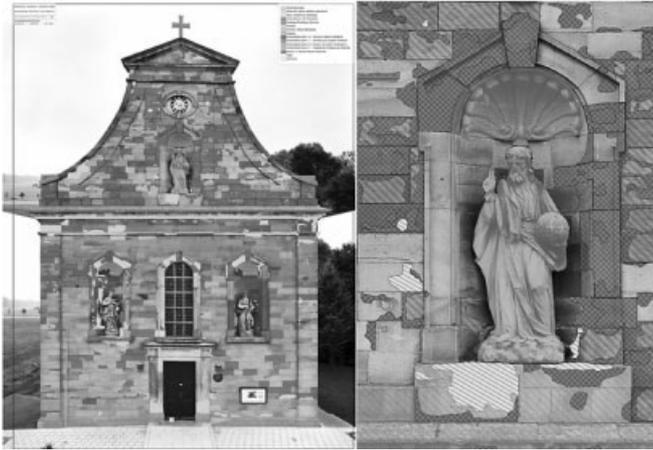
Wallfahrtskirche Ipthausen, Westfassade, Digitale Kartierung des Schadbildes am Werkstein im Bildplan 1 : 25
